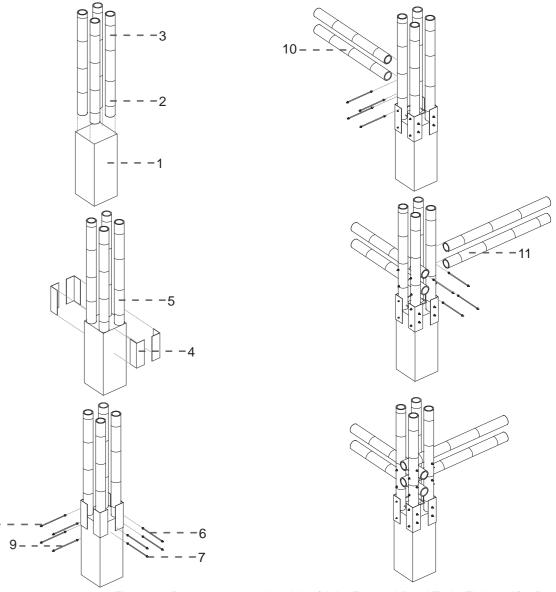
Proceso constructivo del módulo. Fuente: Virtual Tech. Elaboración: Propia
